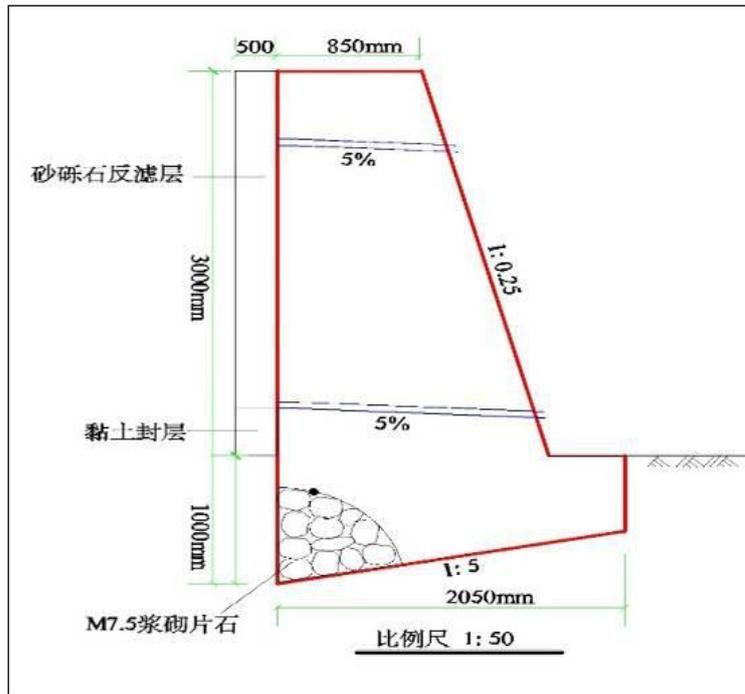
HP1 拦挡墙设计大样图（单位：mm）
